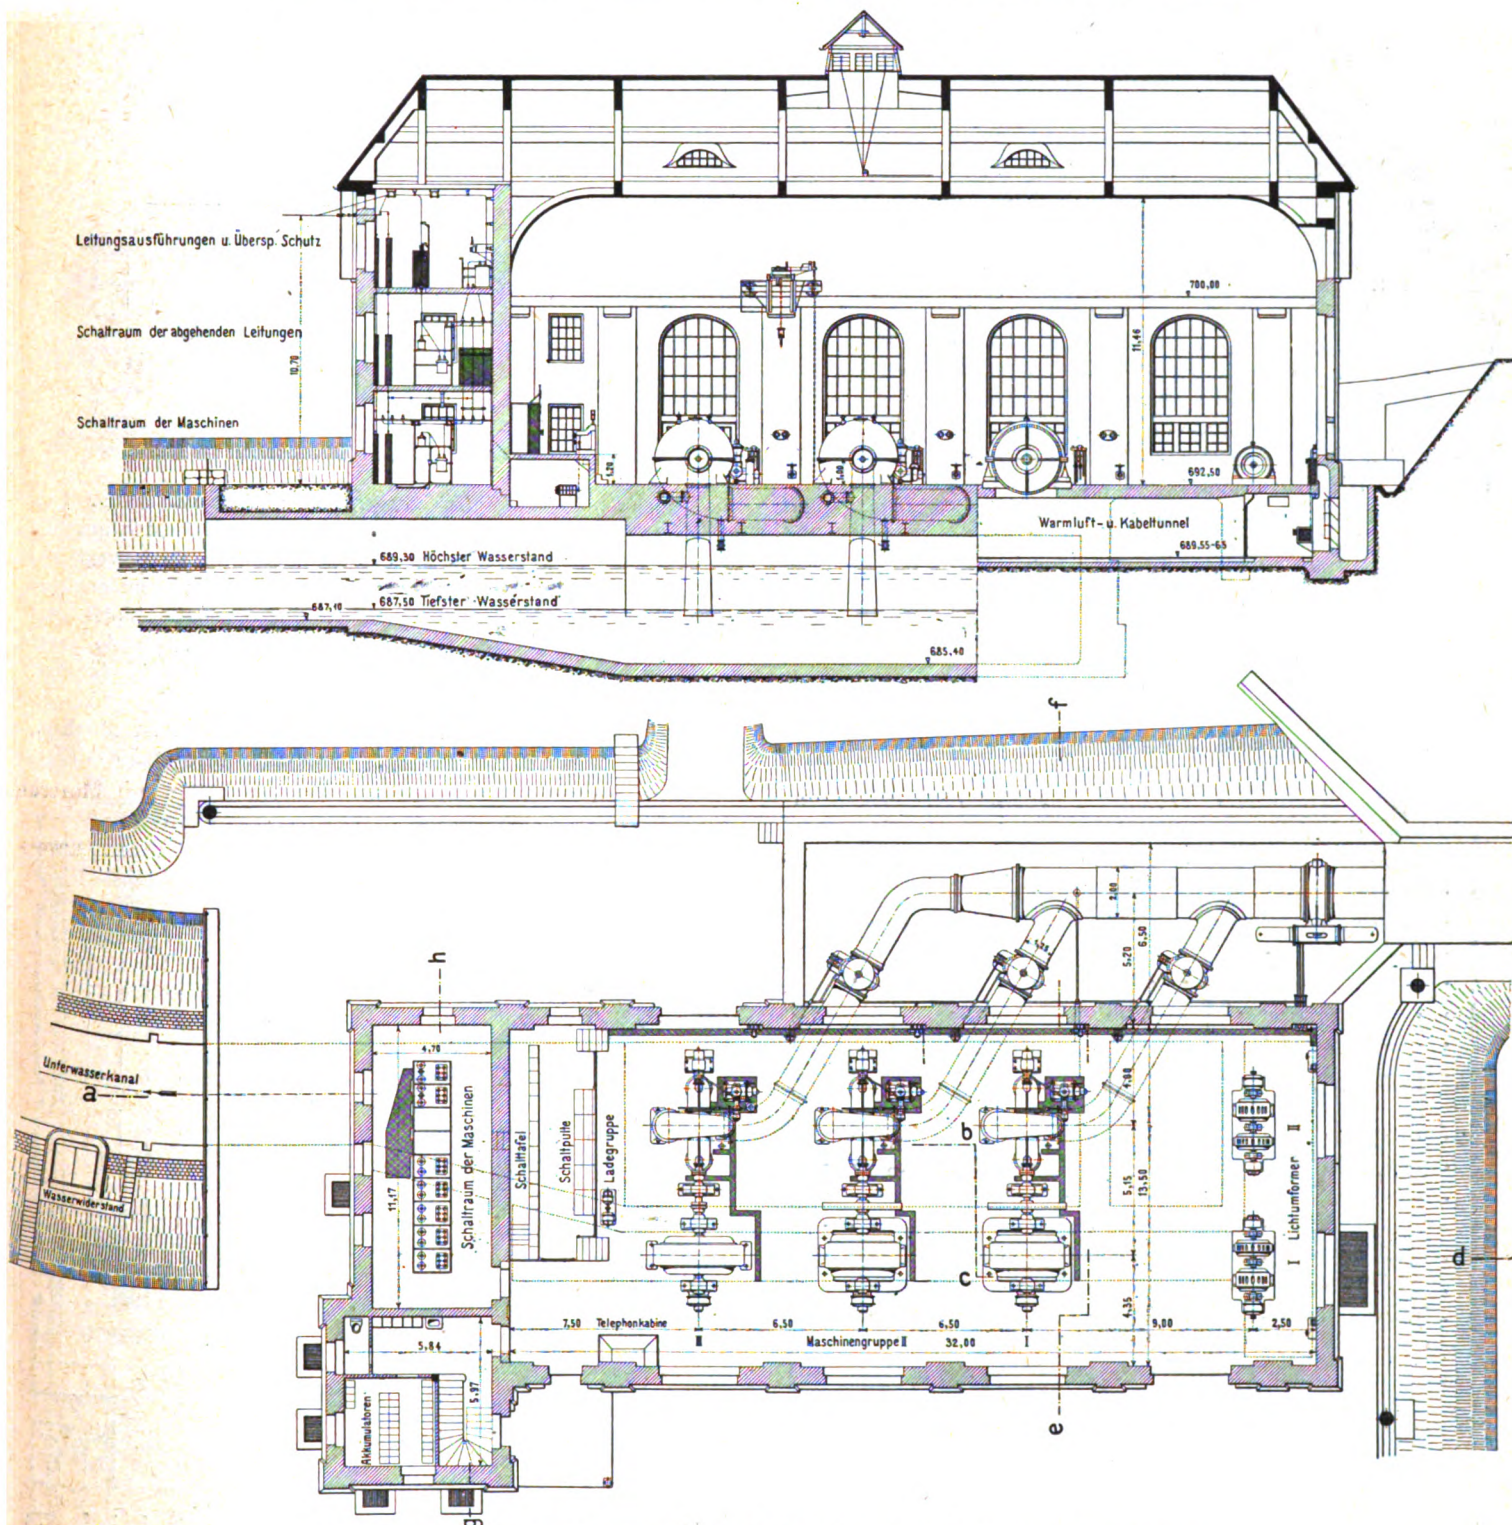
und 17. Grundriss und abgestufter Längsschnitt a-b-c-d des Maschinenhauses. — Masstab 1 : 300.
